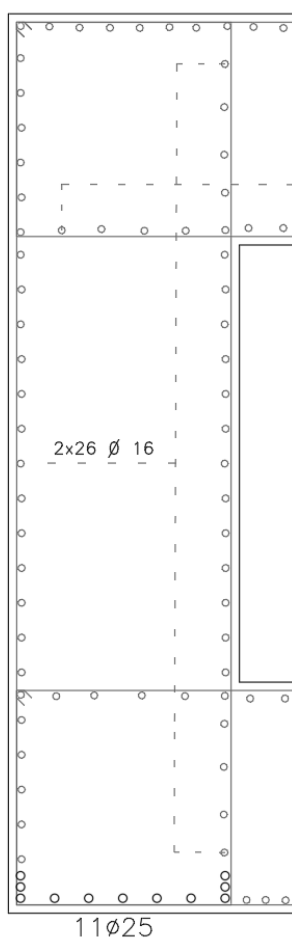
Identificação da armadura longitudinal de tração no alinhamento da alma
